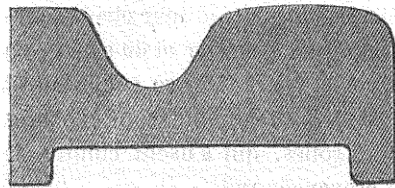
Tramways de Londres. Section d'un rail. Échelle 1/2.
